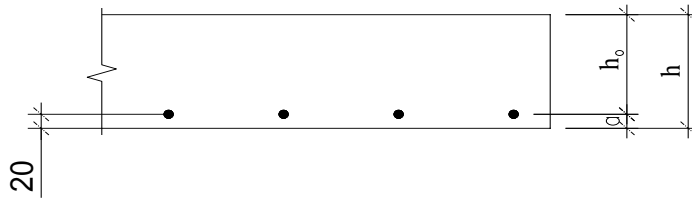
Поперечний переріз перекриття для плити П-1.
